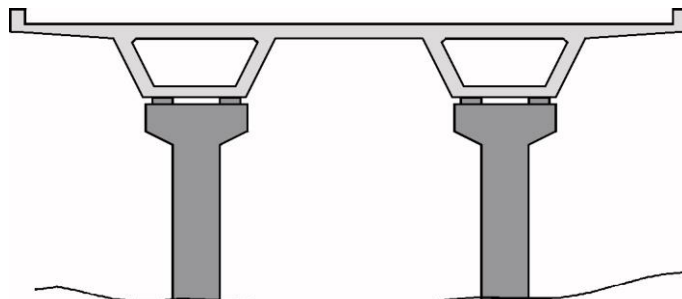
Tipo pilas con dos o más columnas con cabezal
